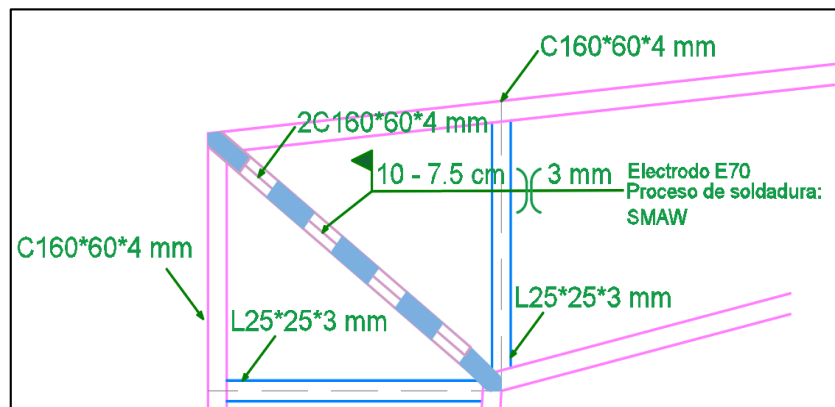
Detalle Soldadura Rodilla.
